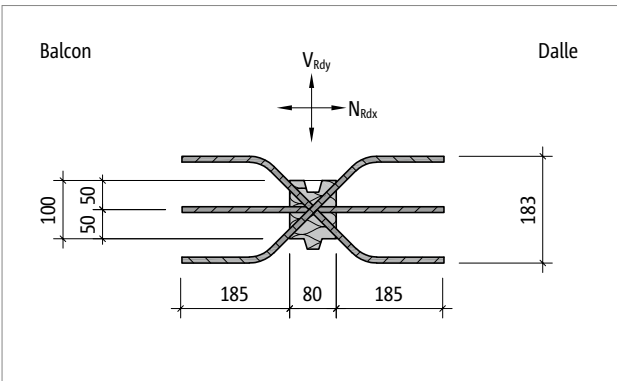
Schöck Isokorb® T Type H-VV1-NN1 : Plan de base du produit
